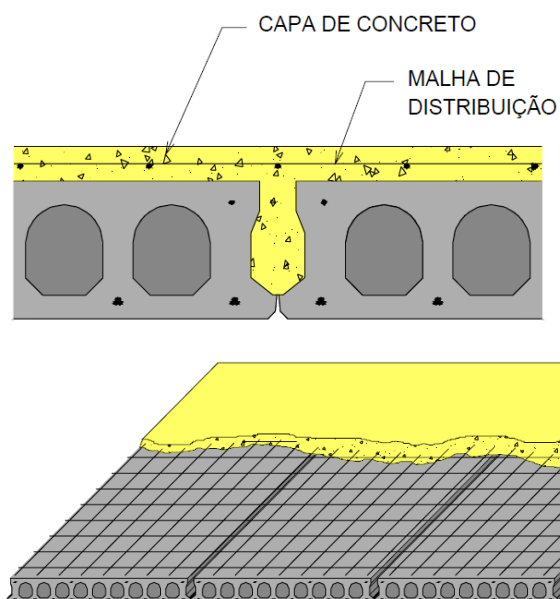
Painéis solidarizados, com capa de concreto e malha de distribuição
